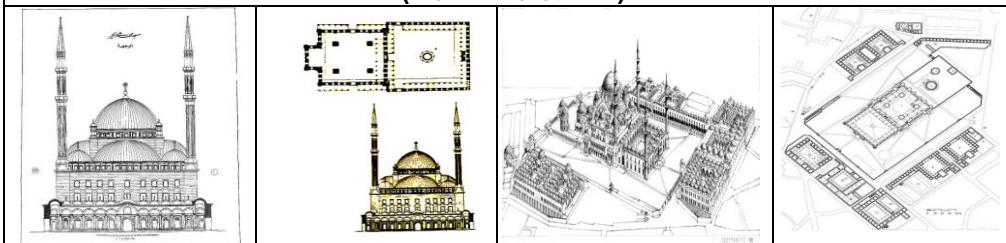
مسقط أفقى وقطع لجامع أوج
